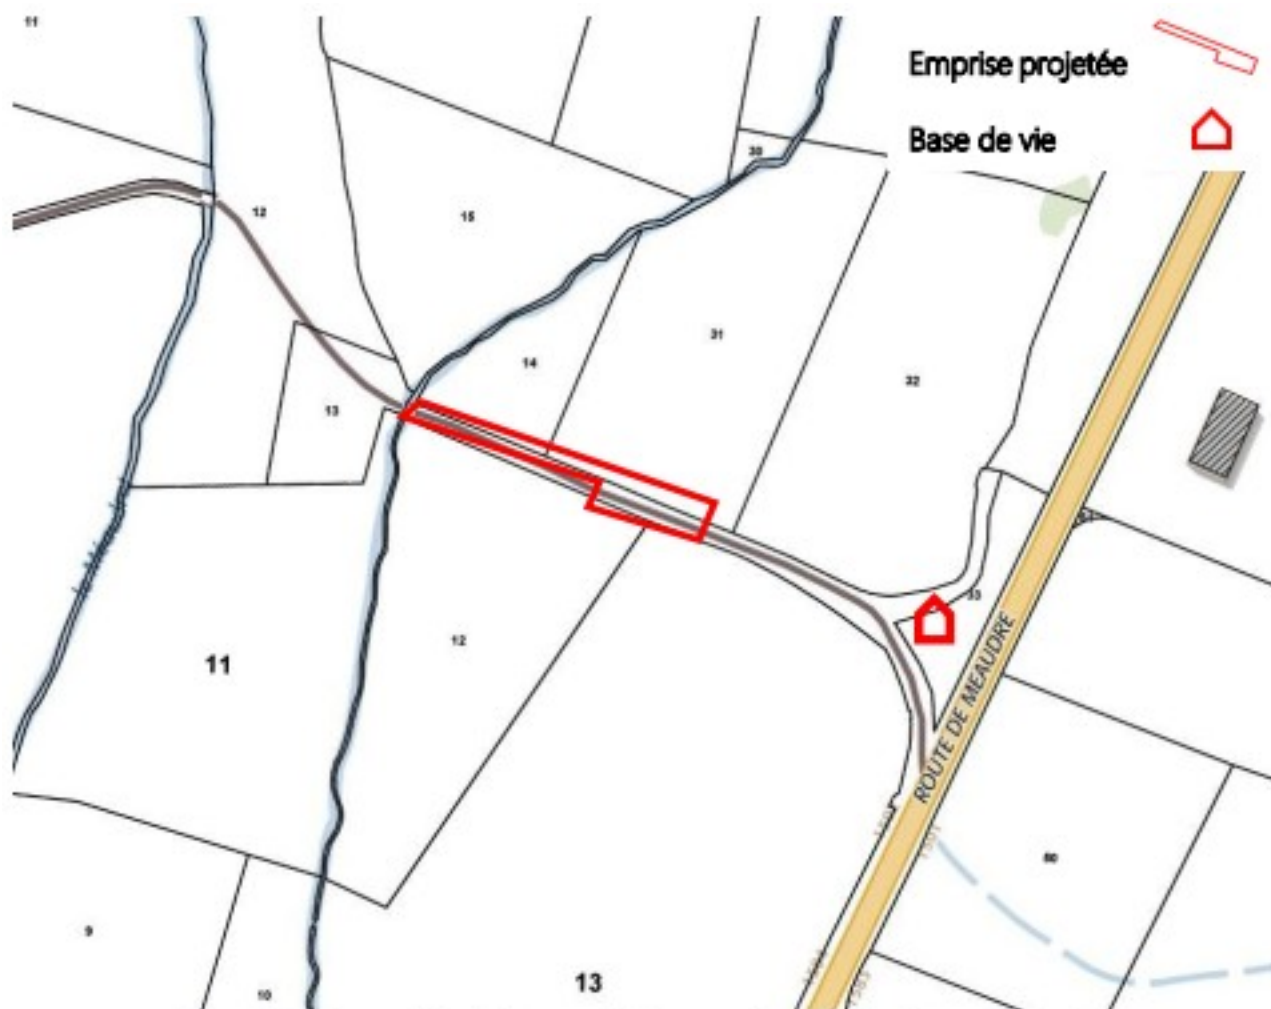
plan parcellaire de la zone d'étude et emprise projetée (source Géoportail)
